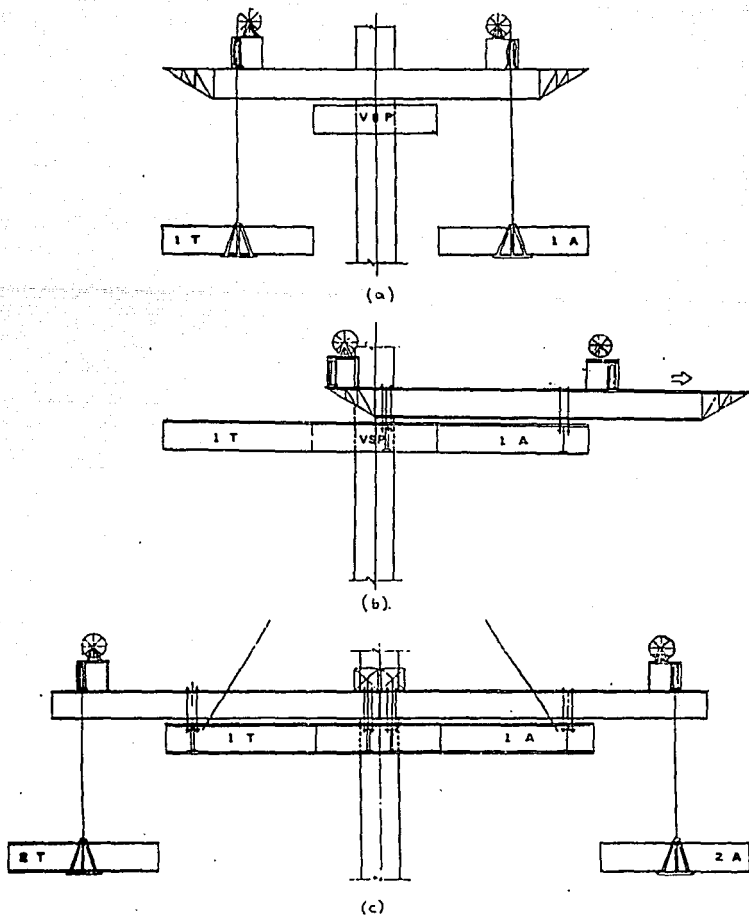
Montaje de Eóvelas contiguas a pila 3
